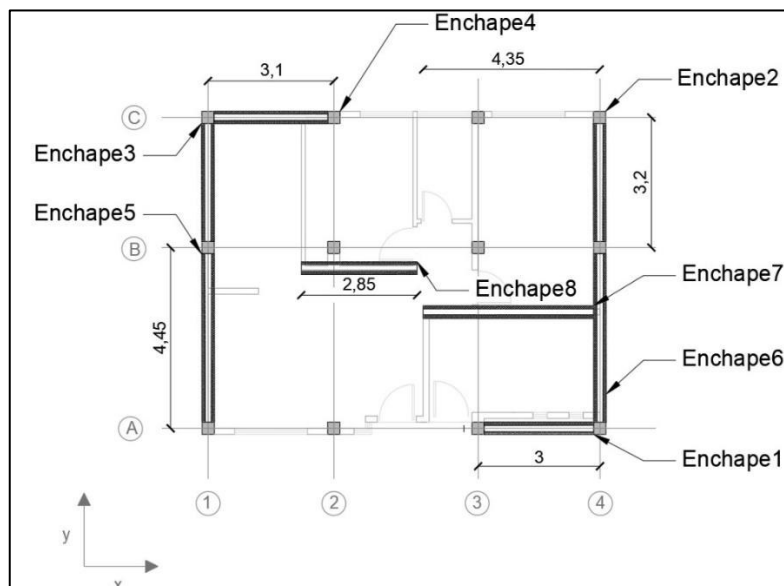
Esquema de ubicación de paredes enchapadas en planta de modelo enchape (E1-Propuesta 1).
